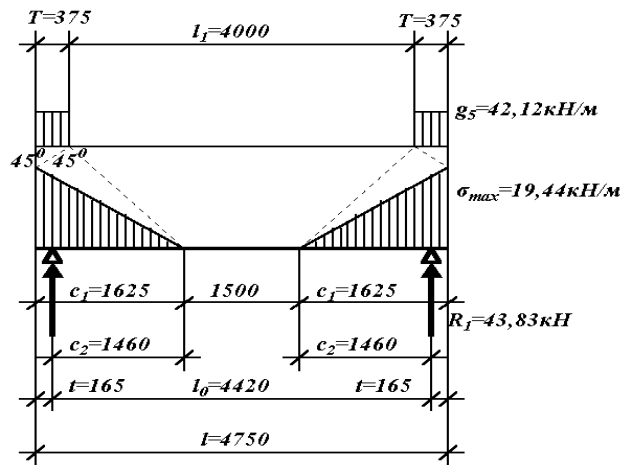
Розрахункова схема фундаментної балки для другого випадку завантаження
